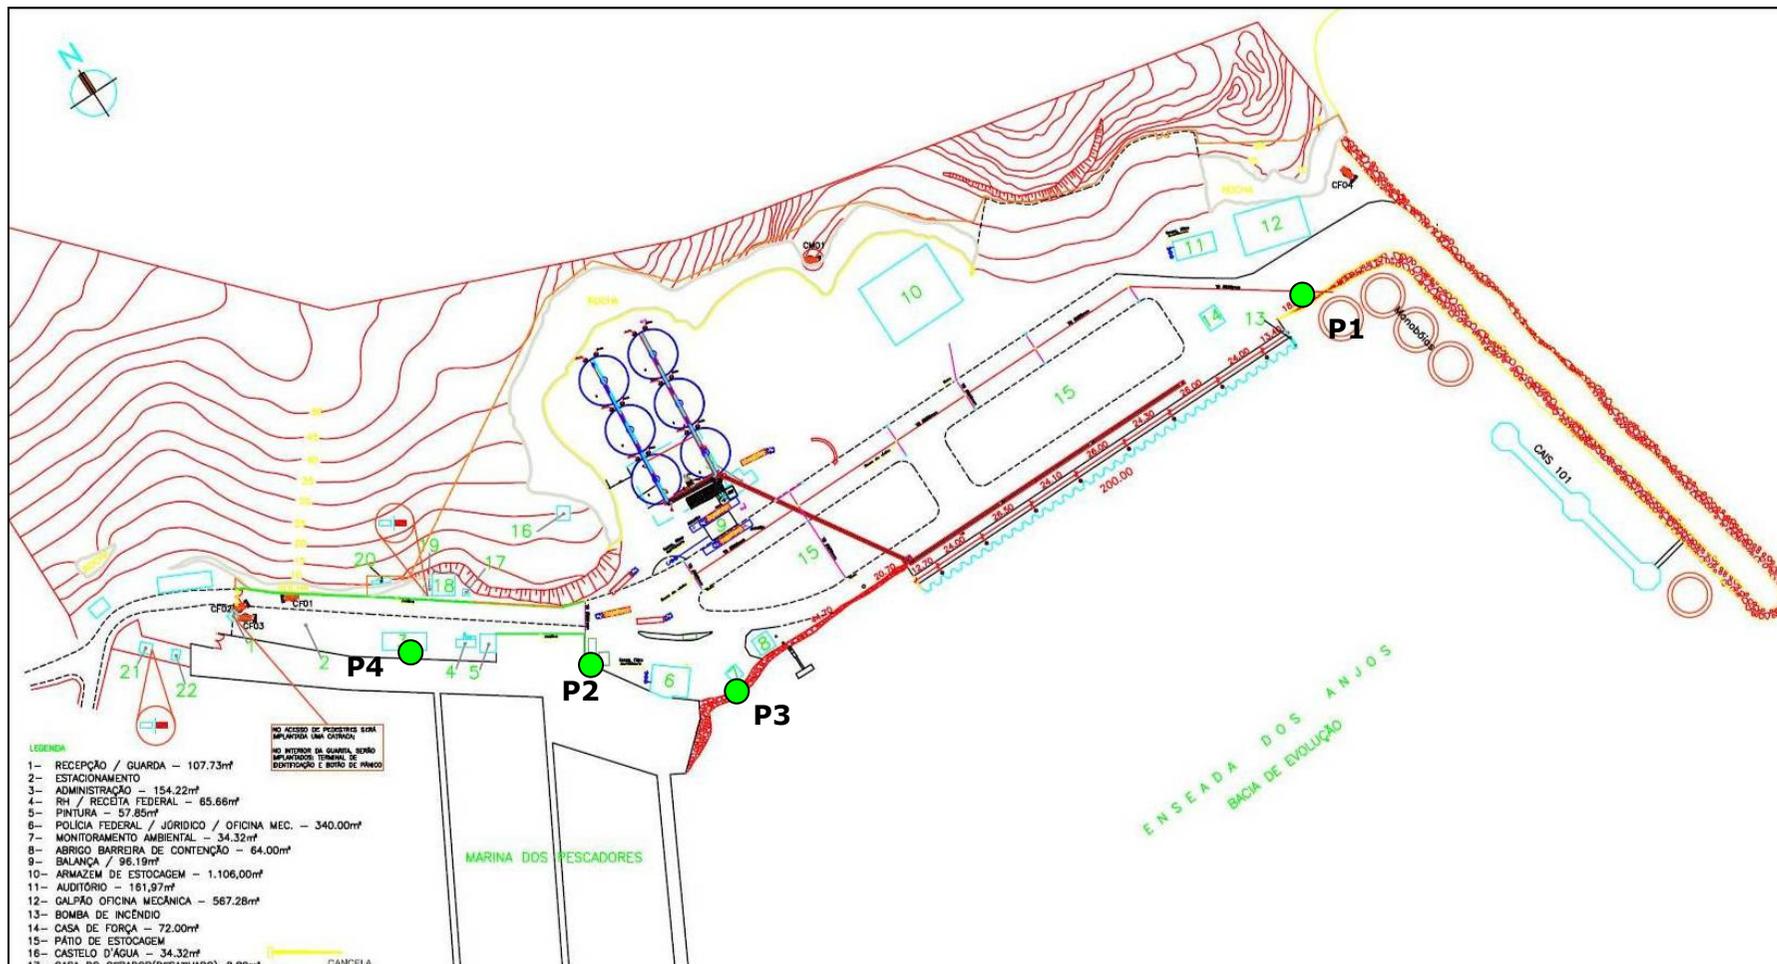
Planta do porto e pontos de saída de águas pluviais.
